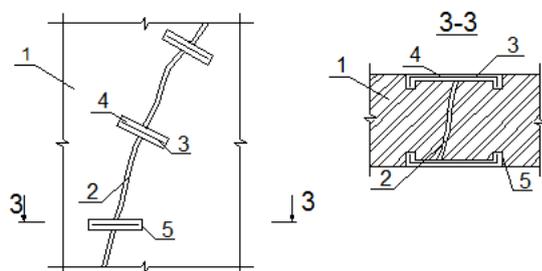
Установка скоб из арматурной стали: 1 – усиливаемая стена; 2 – трещина в стене; 3 – скобы из арматурной стали; 4 – паз в кладке; 5 – углубления по концам
